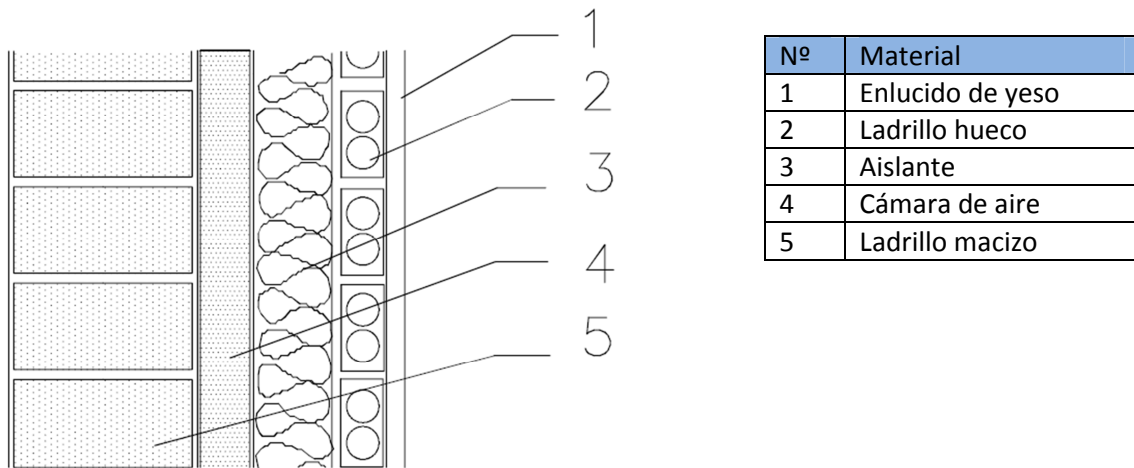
Detalle constructivo y composición de los muros de las paredes exteriores.
